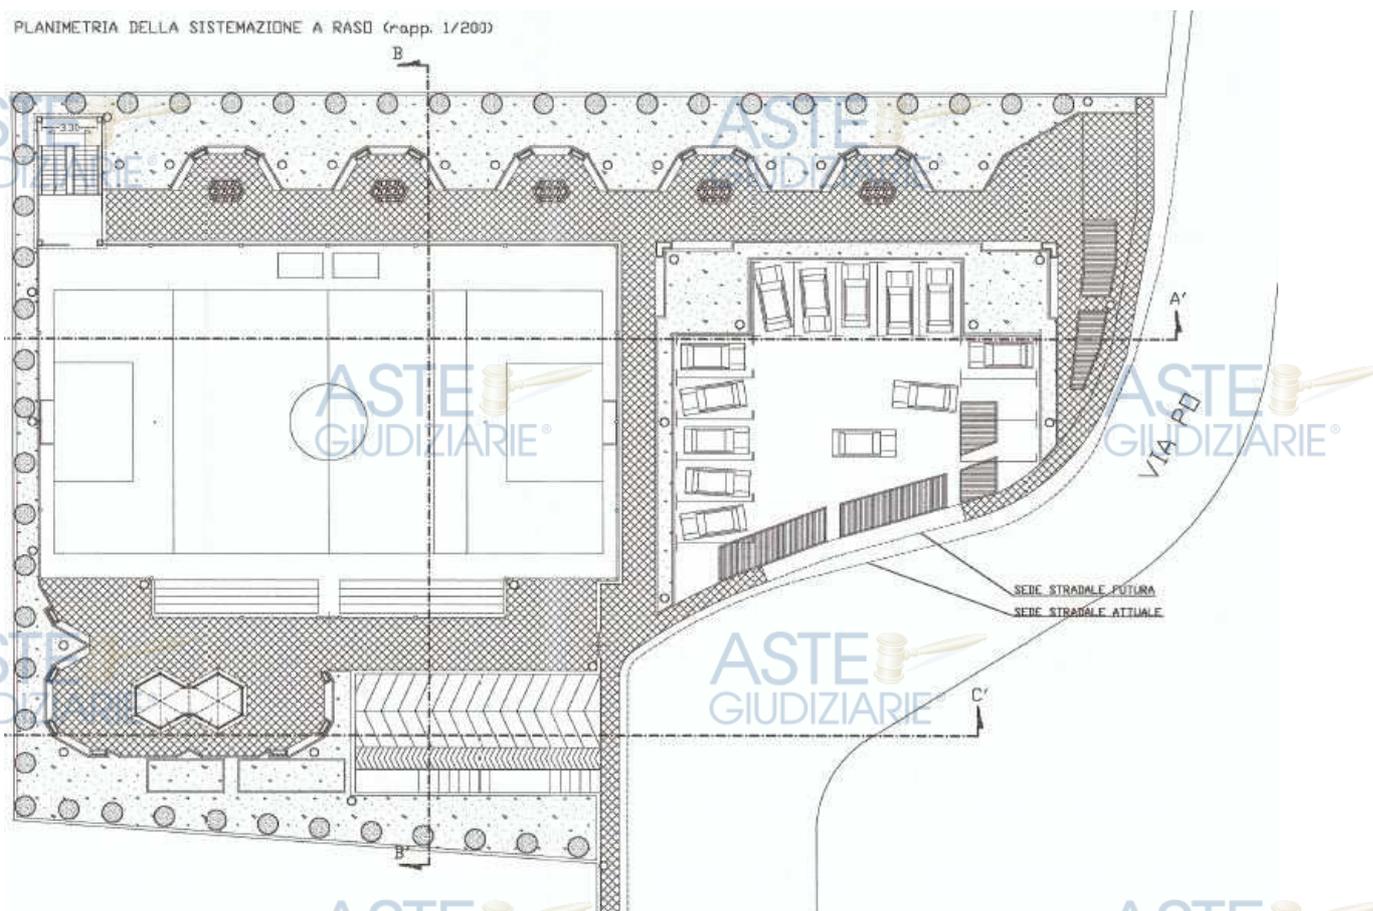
Planimetria sistemazione superficiale autorimessa – grafico estratto dalla Concessione Edilizia n. 32 del 29/08/2000 (cfr. Allegato 3)
